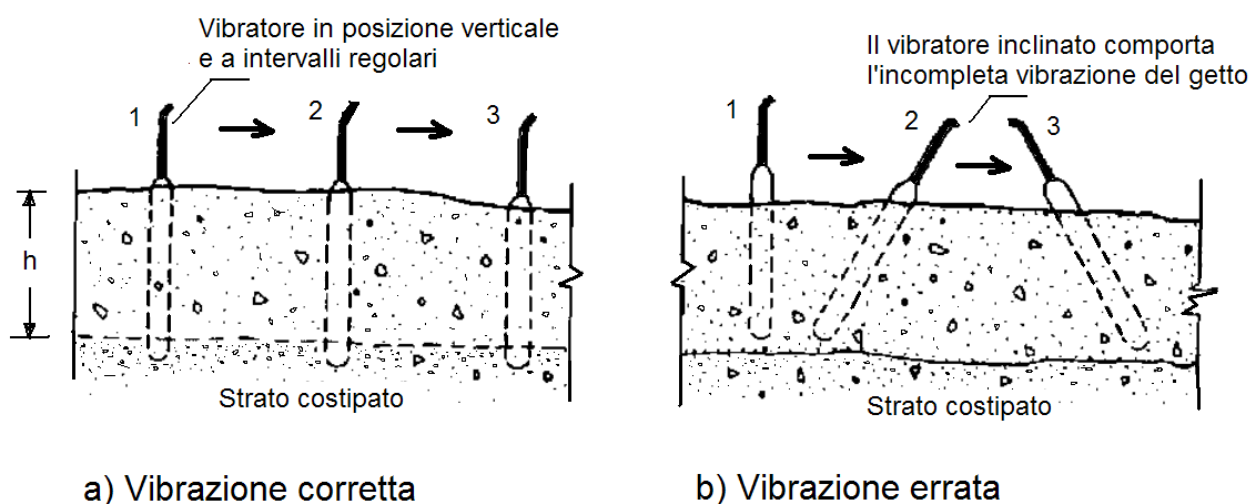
Esecuzione del getto e modalità di costipazione mediante vibrazione interna
